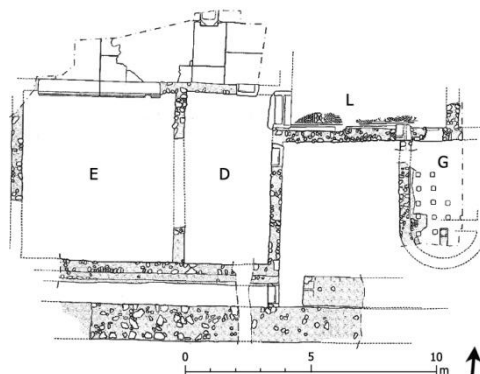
Casa Crivelli - Casa Merlin, Grundriss.
